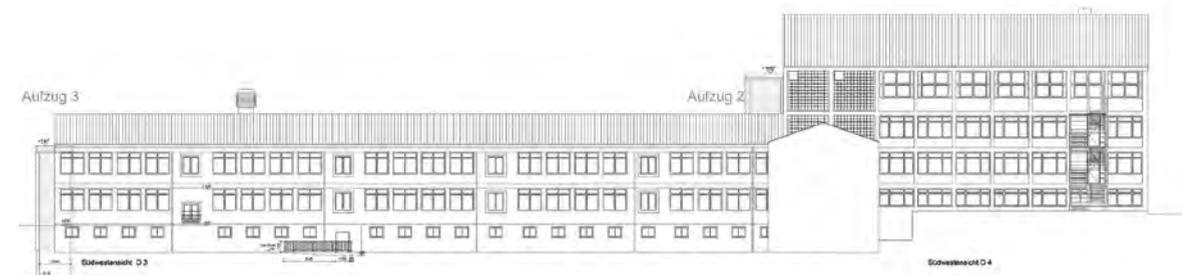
Fassade Südwest, Gebäude D3 und D4
